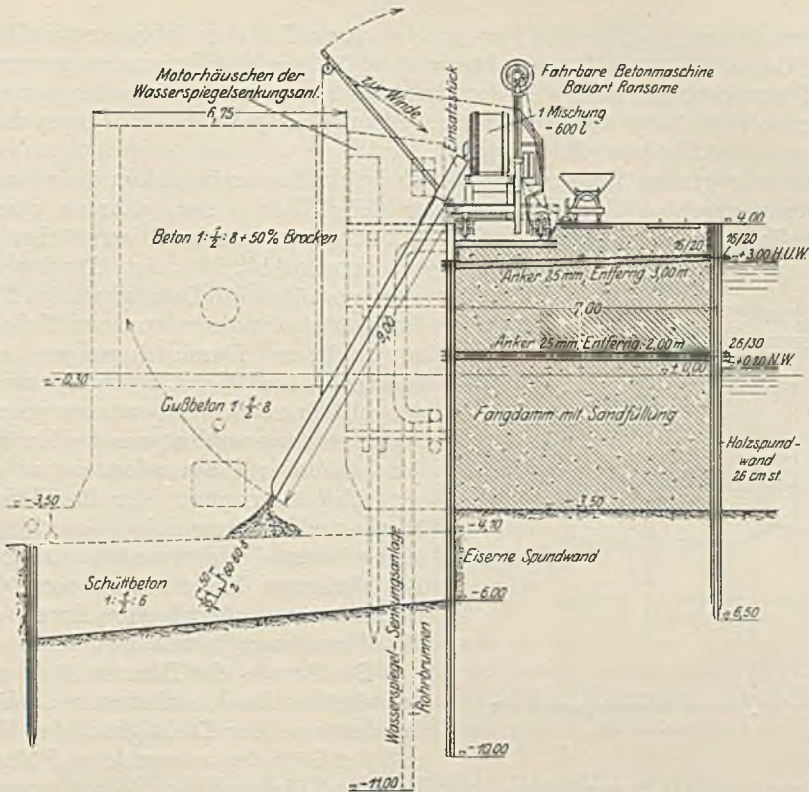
Fangedamm für die Wiederherstellung der Schleusenmauer in Hemelingen. Statt Steifen besser nur Zuganker.
